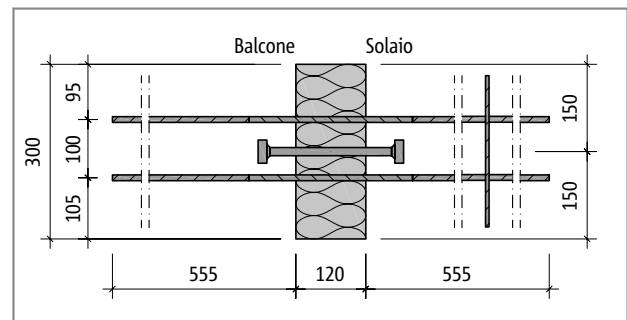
Schöck Isokorb® tipo QPXT10: pianta del prodotto
